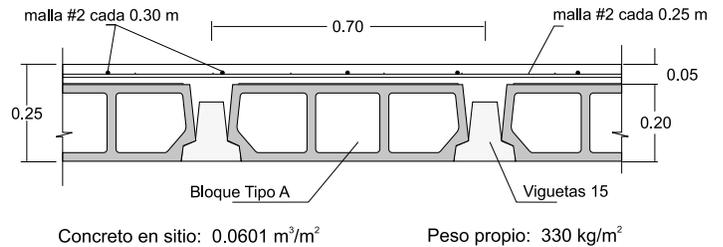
Detalle típico de entrepiso de vigueta de 15 cm con bloque tipo A
